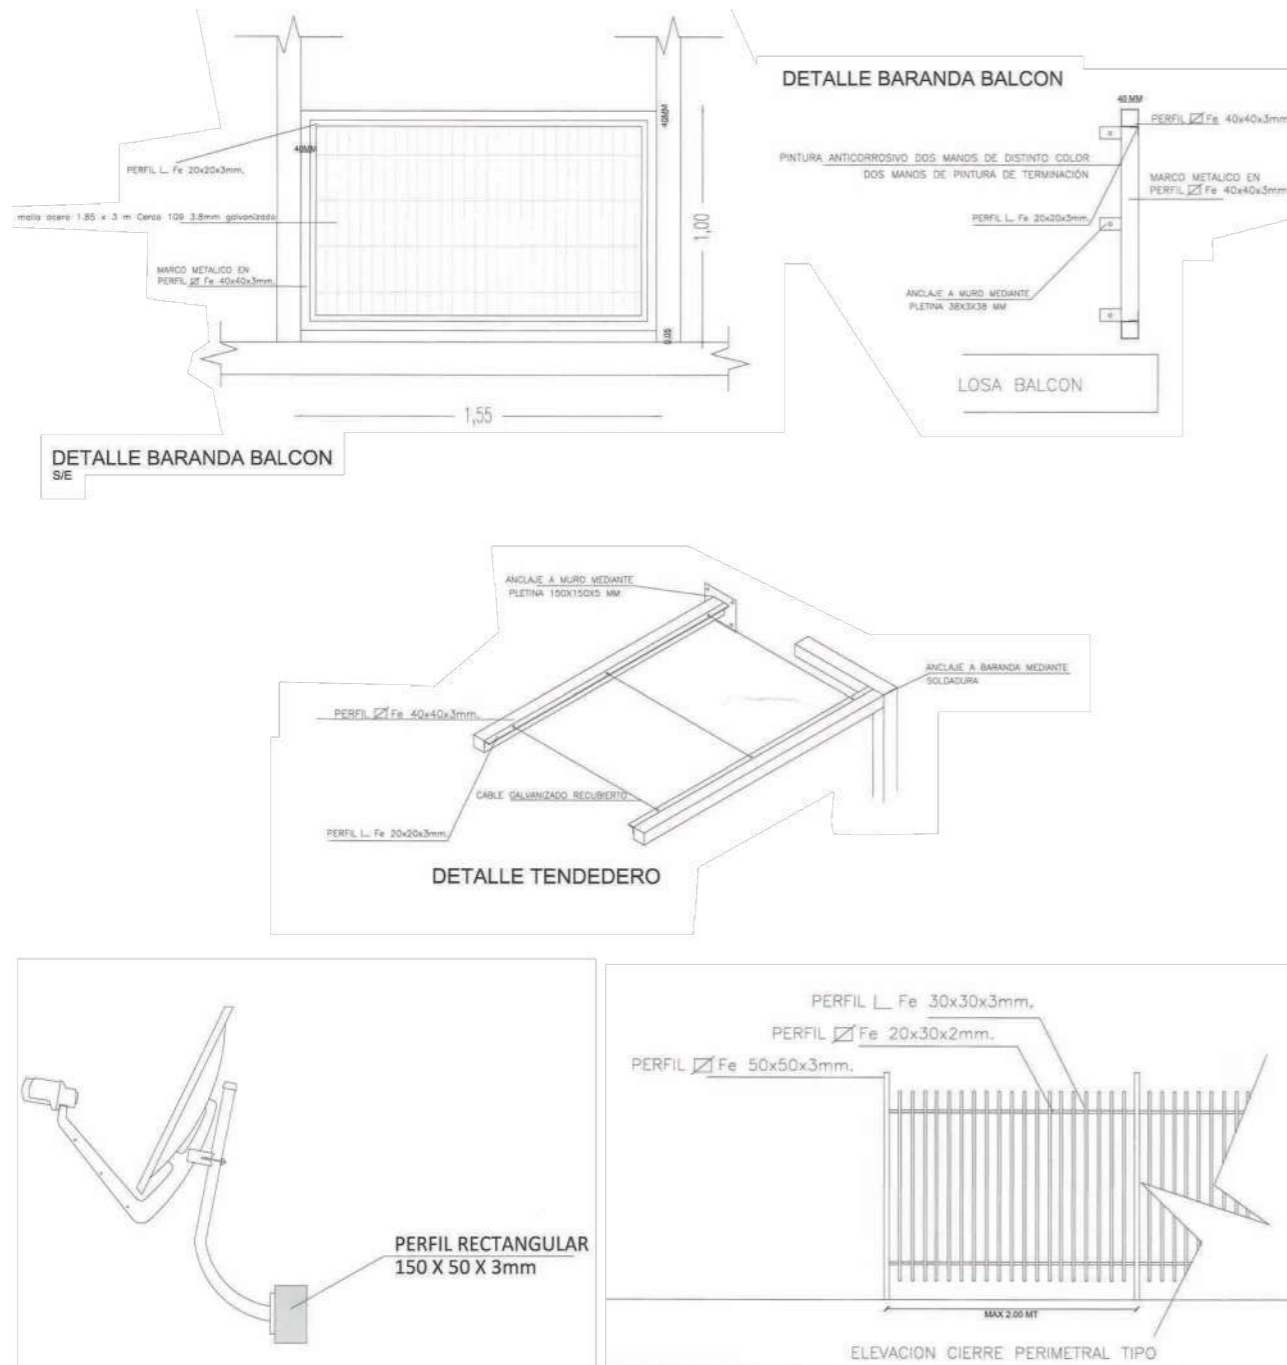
Plano detalles baranda balcón, tendedero, antena y reja perimetral
